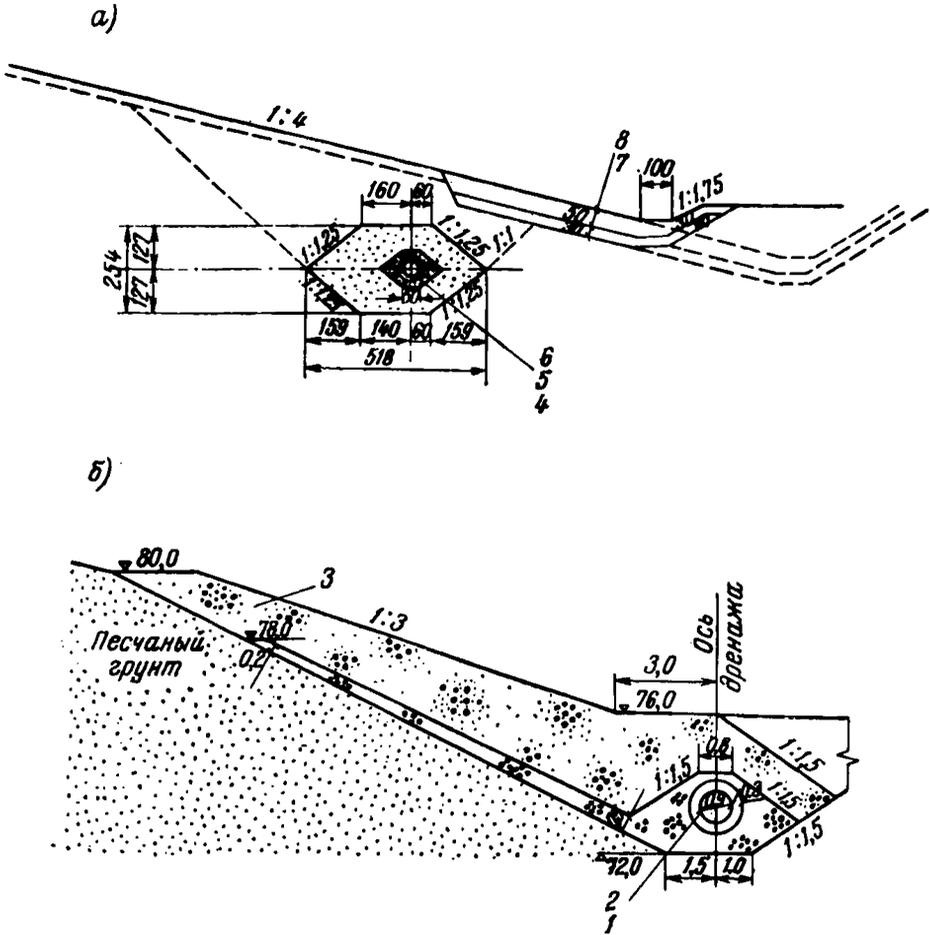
Конструкция дренажа из пористого бетона (а) и та же конструкция при наклонном дренаже (б)
